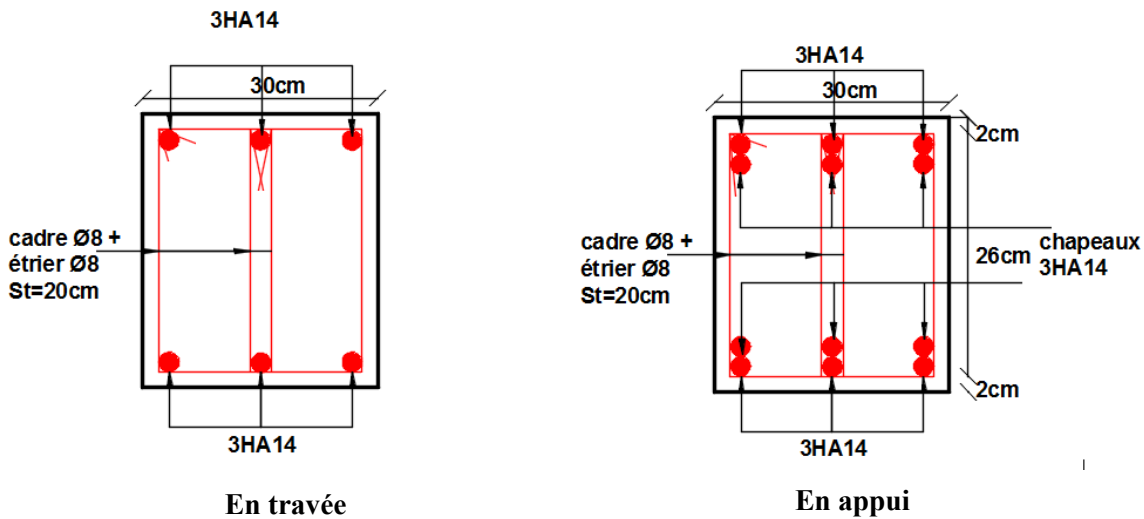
Schéma de ferrailage des Poutres Secondaires RDC
